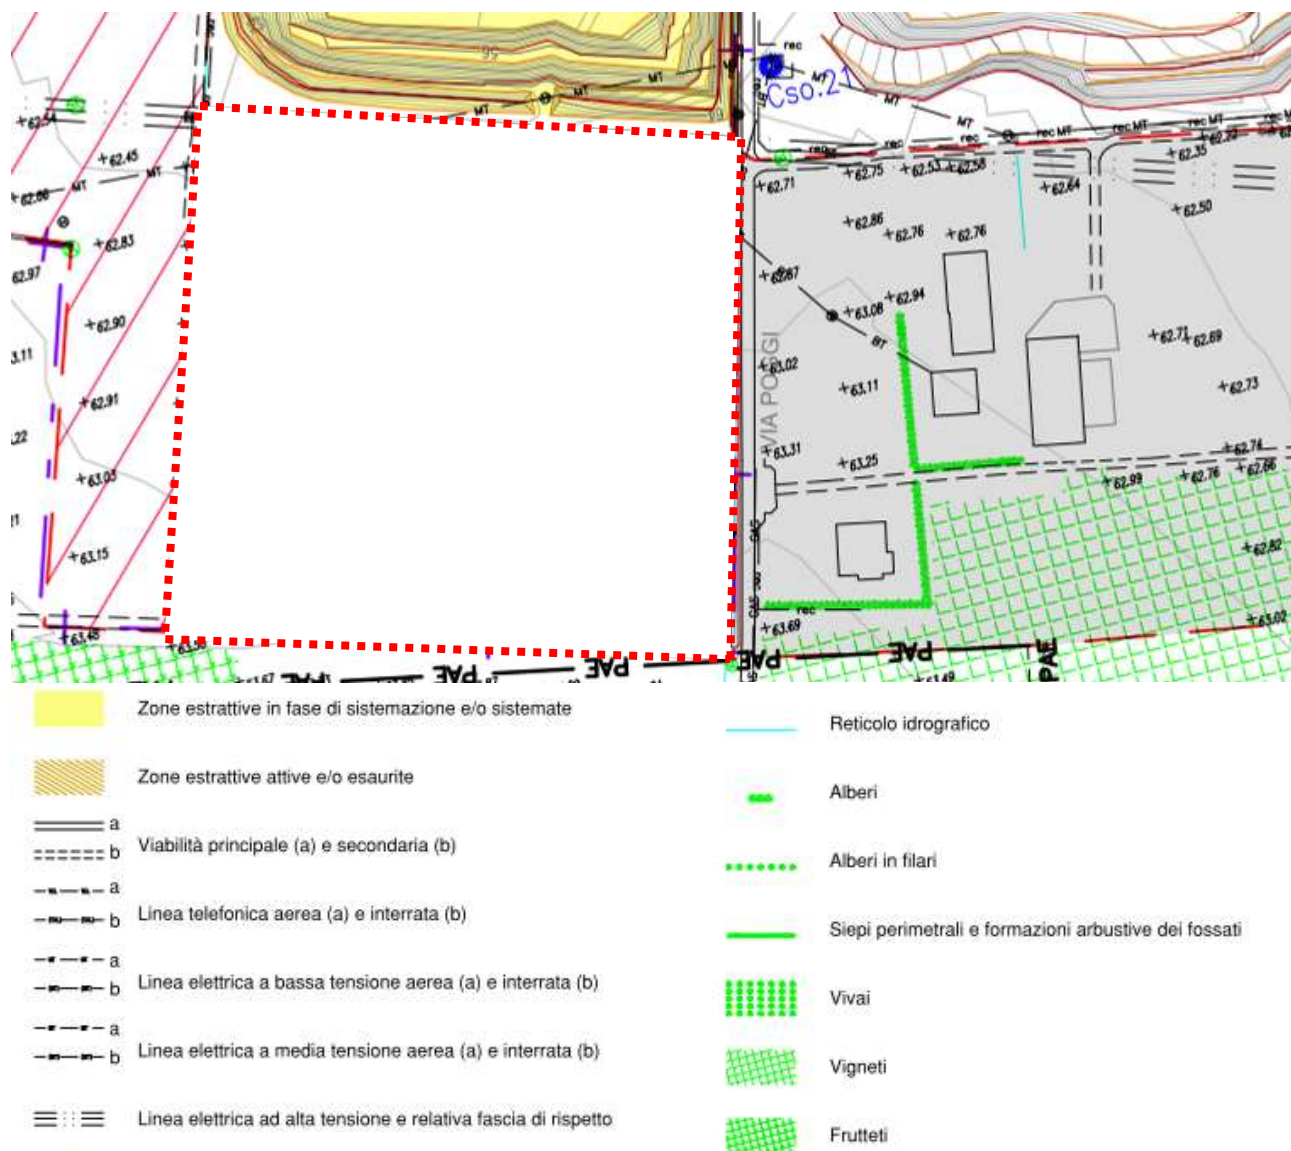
Estratto da tavola 2.2.a del PC "Progetto – Planimetria dello stato di fatto"
